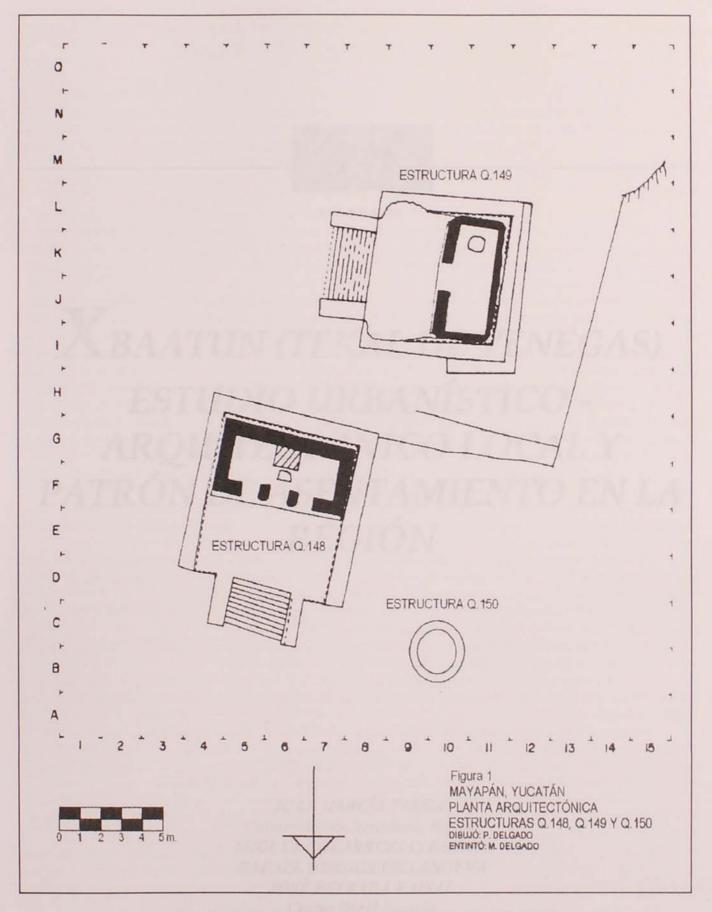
Mayapán, Yucatán Planta arquitectónica, estructuras Q.148, Q.149 y Q.150.
